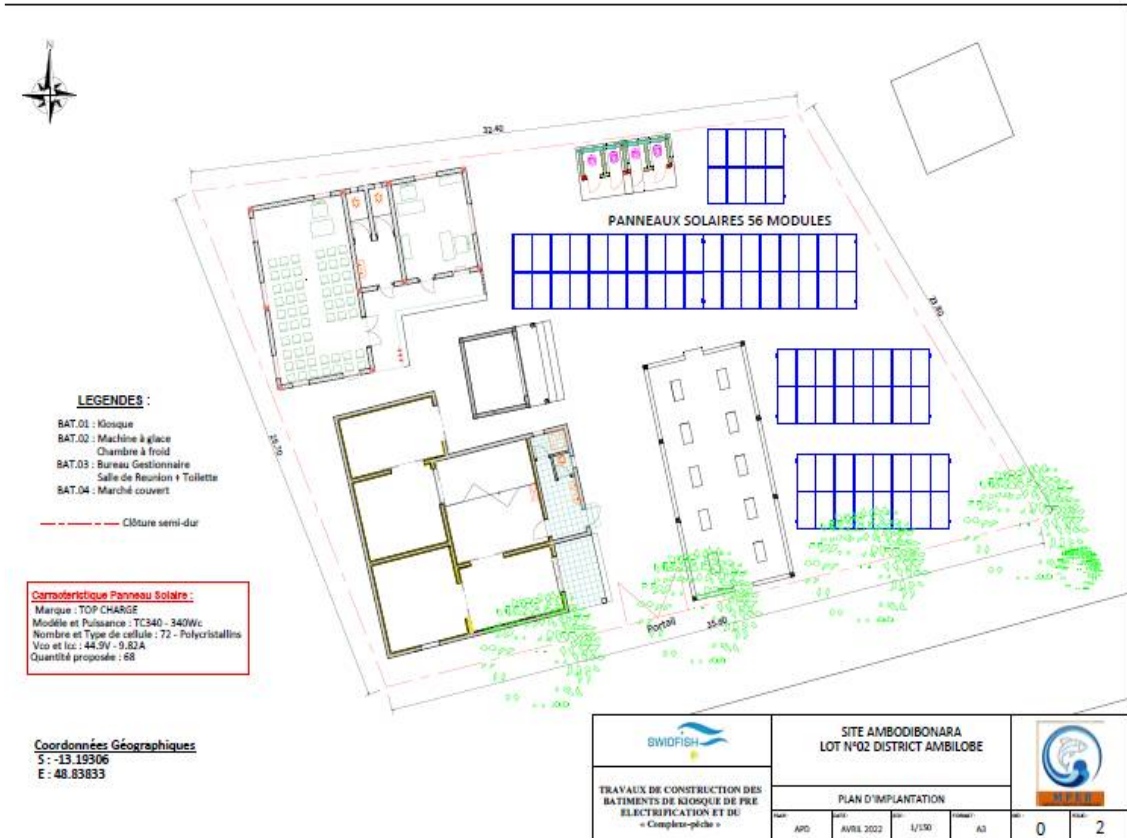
Plan de masse du complexe pêche à Ambodibonara
